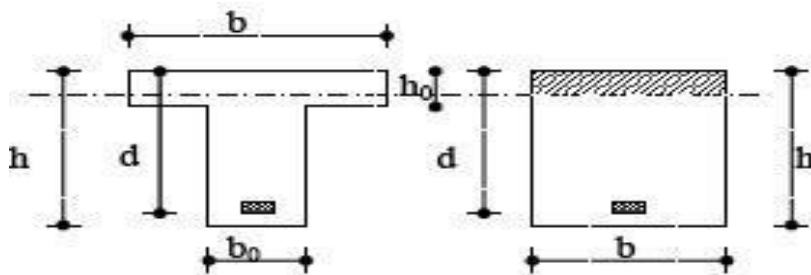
Coupe de Section Rectangulaire et Section en T
